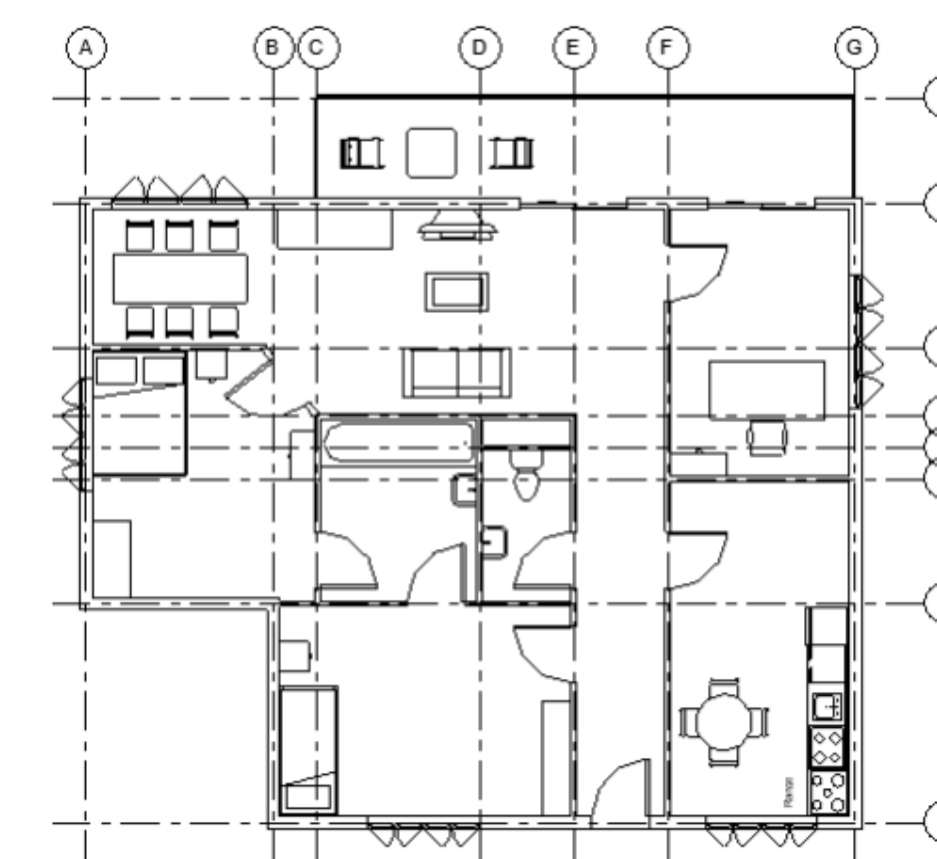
Plano de vivienda remodelada. Fuente: Imagen propia
